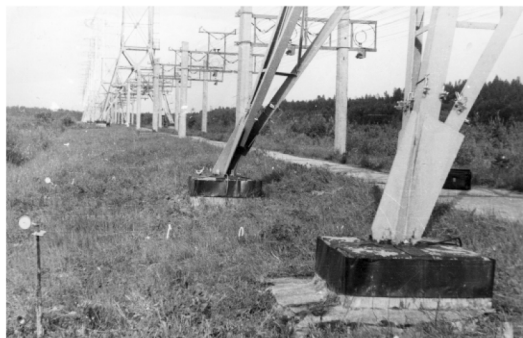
Исследование совместной работы конструкций и основания радиобашни высотой 42,0 м при испытаниях на вертикальное смещение опорного узла с замером перемещений монолитных фундаментов и усилий в поясах и раскосах (ЛИСИ, 1979)
